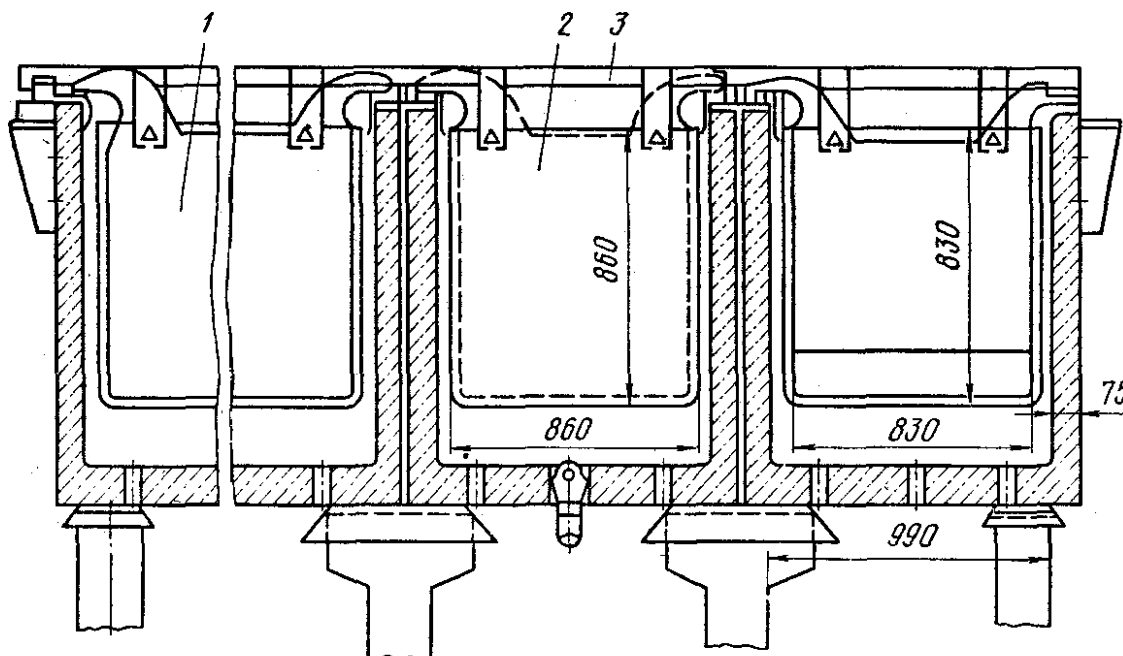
Блок железобетонных ванн (поперечный разрез): 1 – анод; 2 – катод; 3 – катодная штанга
